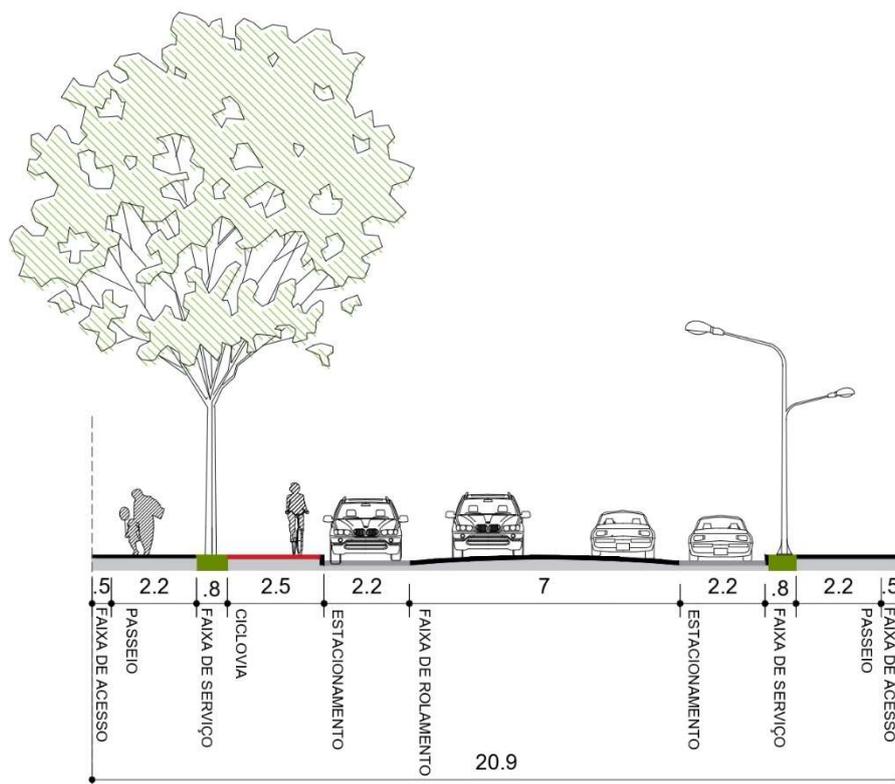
Perfil da Via de Circulação de vizinhança 1 (Rua 1)
